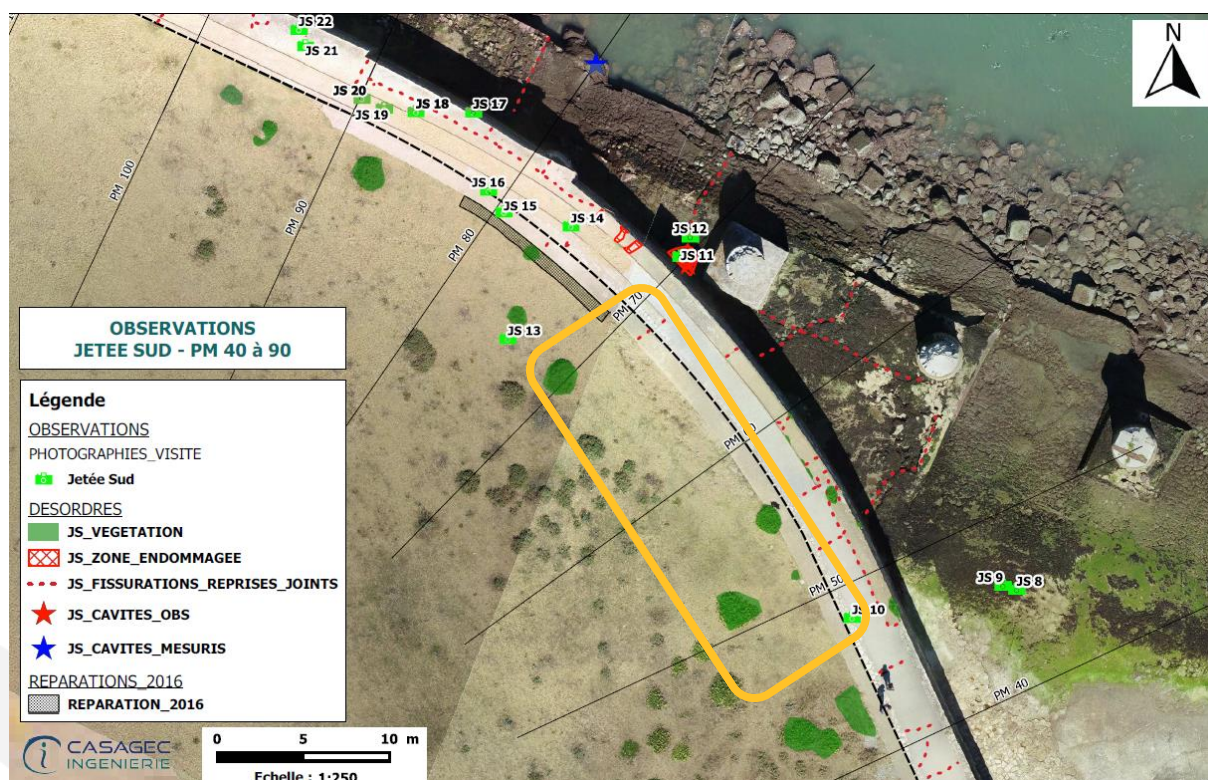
Plans de localisation des désordres et des travaux à prévoir (source fond de plan : ANTEA/CASAGEC 2020)
